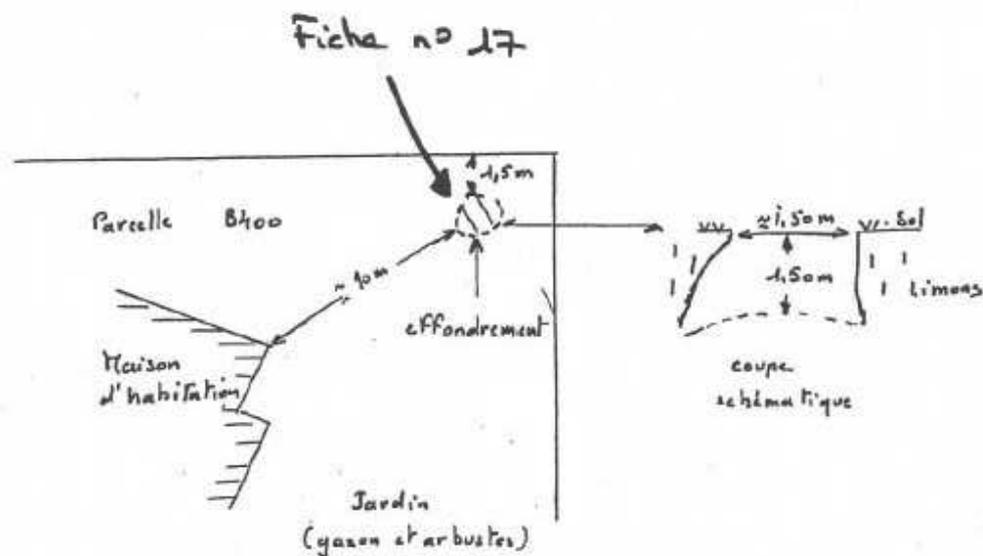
Plan et coupe schématiques de l'effondrement.
